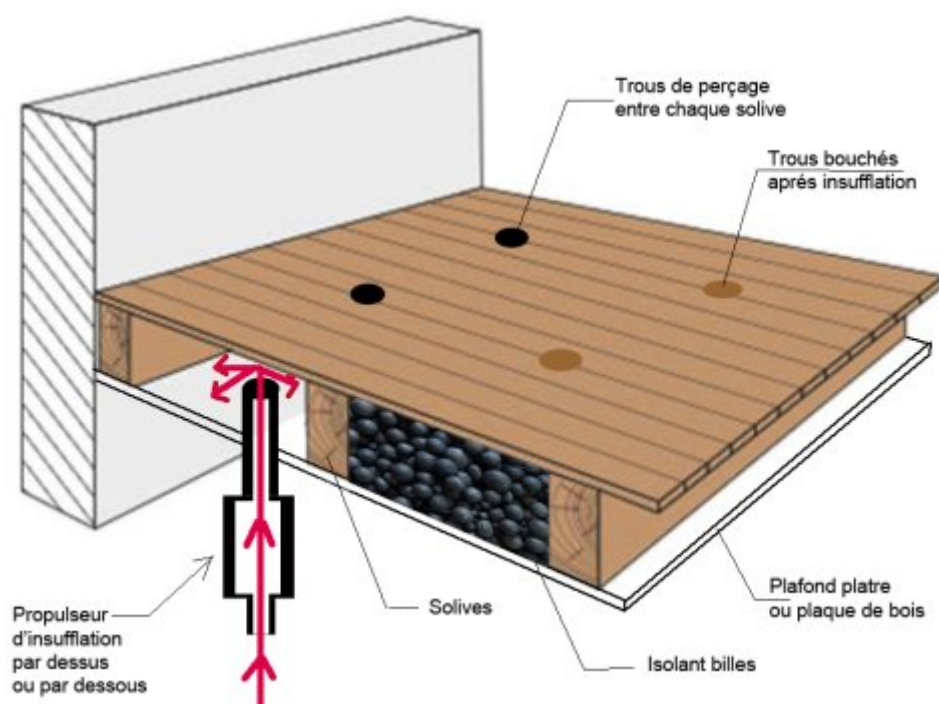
Insufflation par-dessus ou par-dessous le plancher
